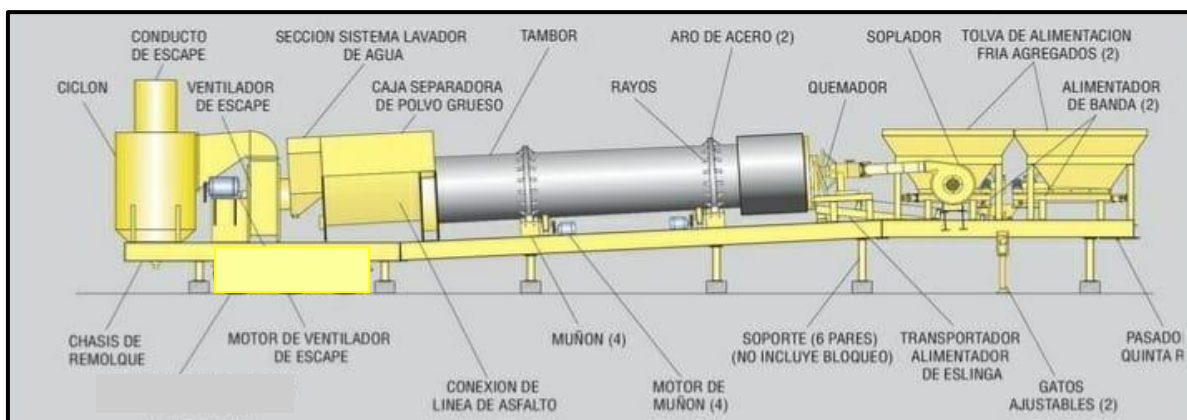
Detalle de una Planta de Produccion Hormigón Asfáltico.
